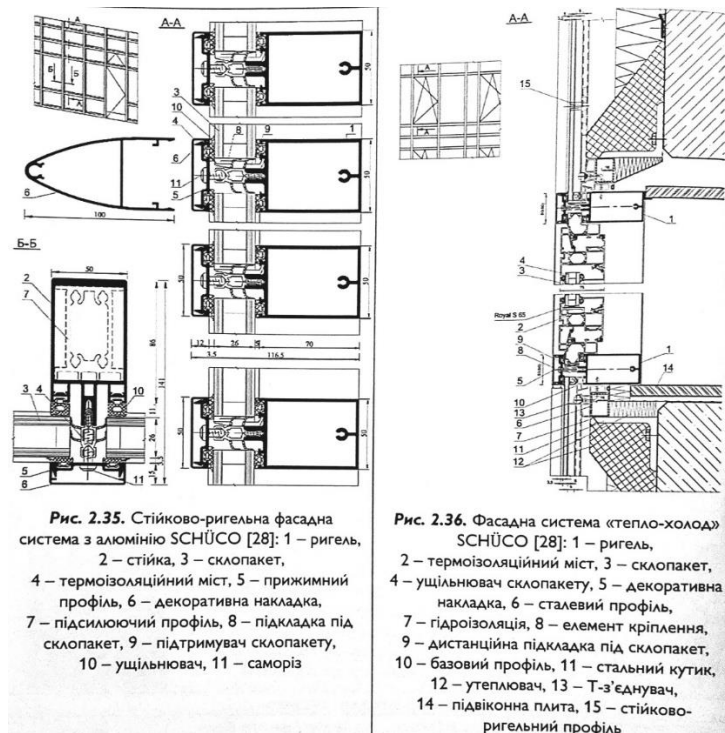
Вузли кріплення стійково-ригельної фасадної системи [24]
